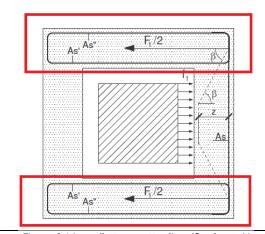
spallette oggetto di verifica lungo Y
